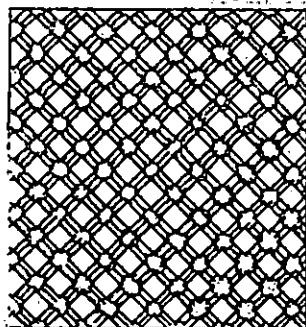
مسقط افقي لقبة سيدى حمزة القبىه .
